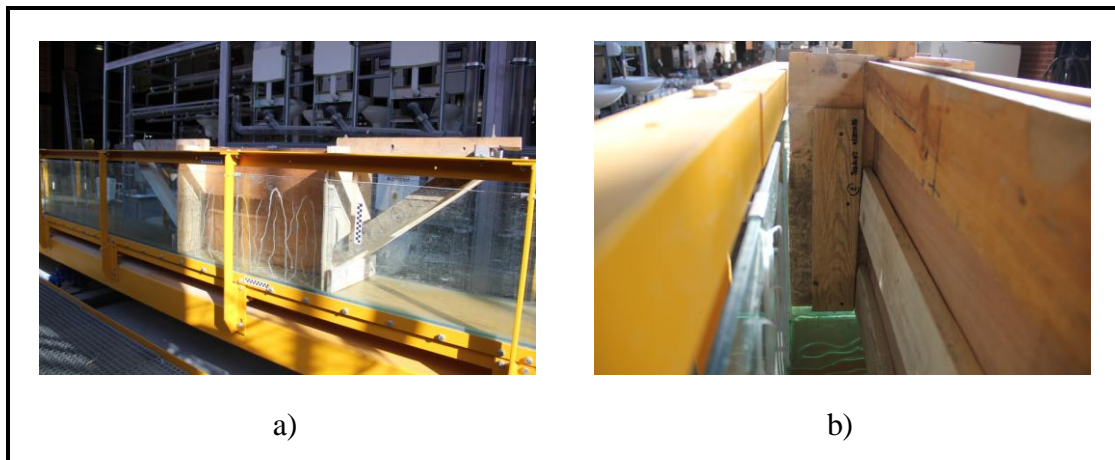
Elemento de cofragem para o ensaio de erosão lateral e frontal: a) Vista geral da estrutura; b) Pormenorização das condições de apoio.
